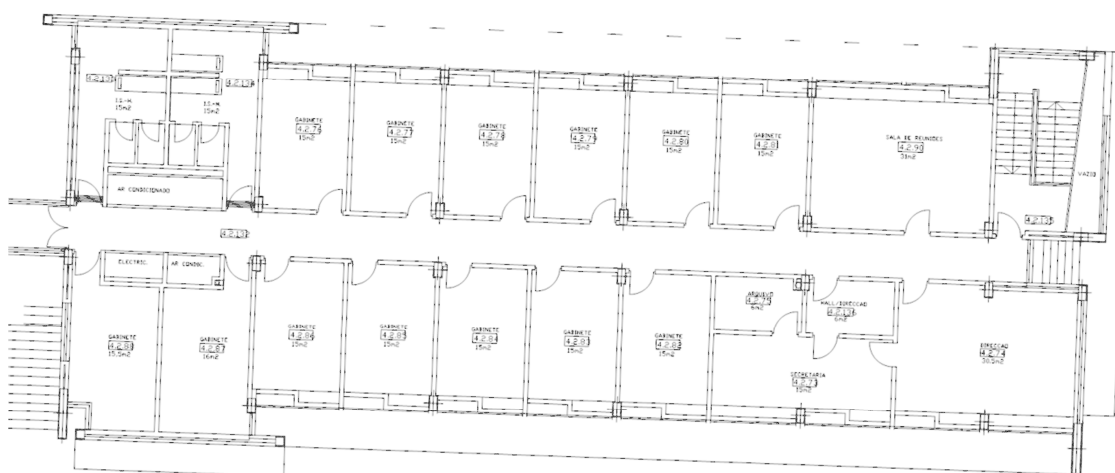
Vista superior detalhada do corpo Norte, piso nº4.
